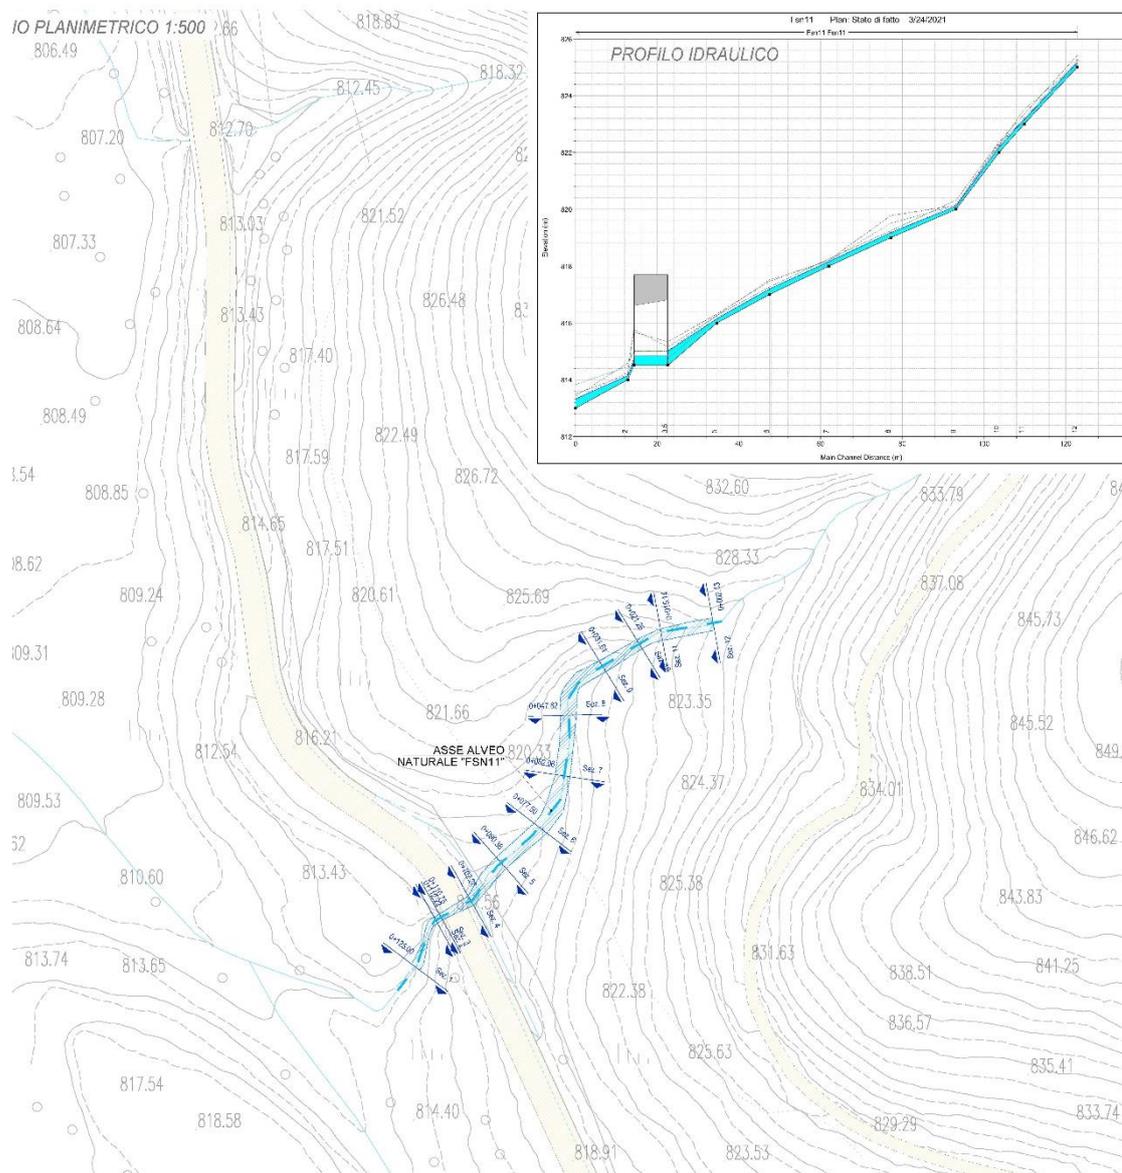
Fosso Fsn11 – Planimetria stato di fatto con area di esondazione TR 200, profilo idraulico e traccia della strada di progetto..
